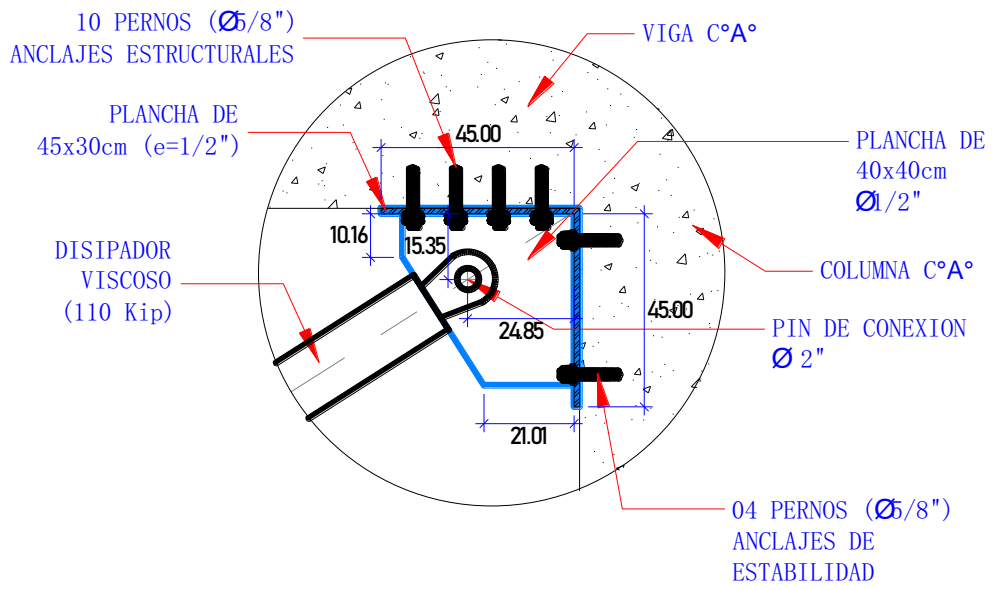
Detalle 2 (Conexión: Disipador – Cartela – Estructura de concreto)
